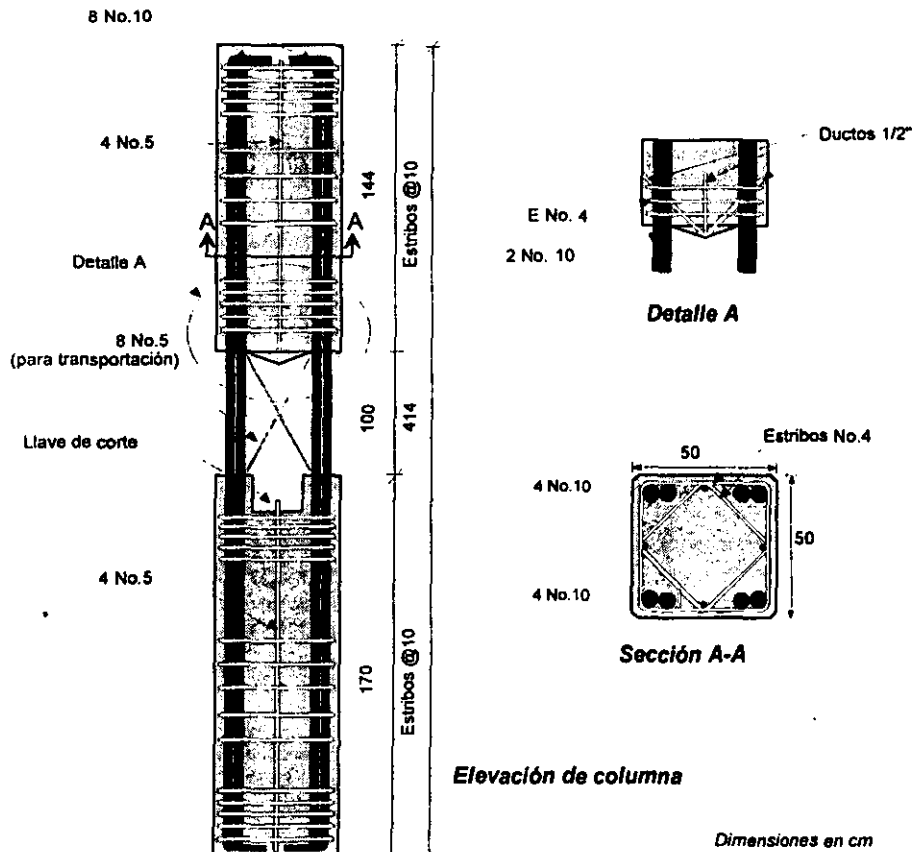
Geometría y armado de la columna del modelo J-E
